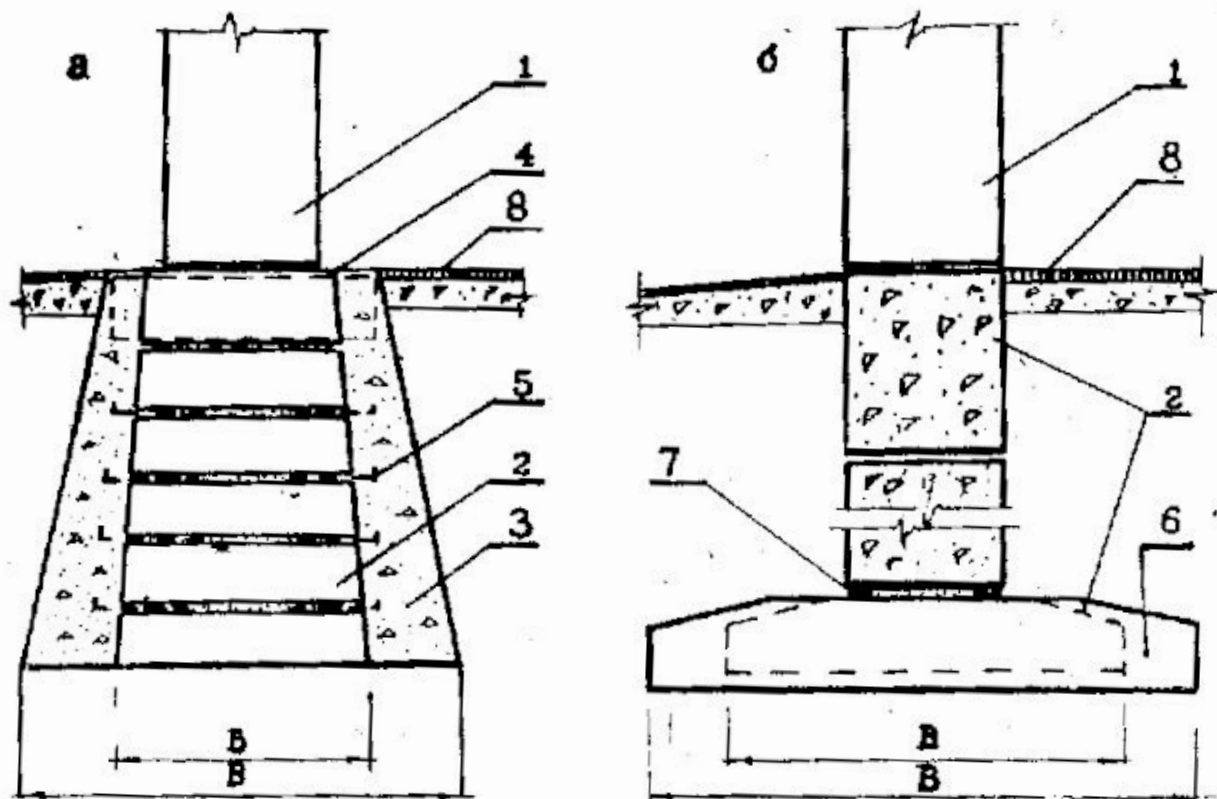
Конструктивные решения при уширении подошвы фундамента (а — монолитного; б — сборного):
